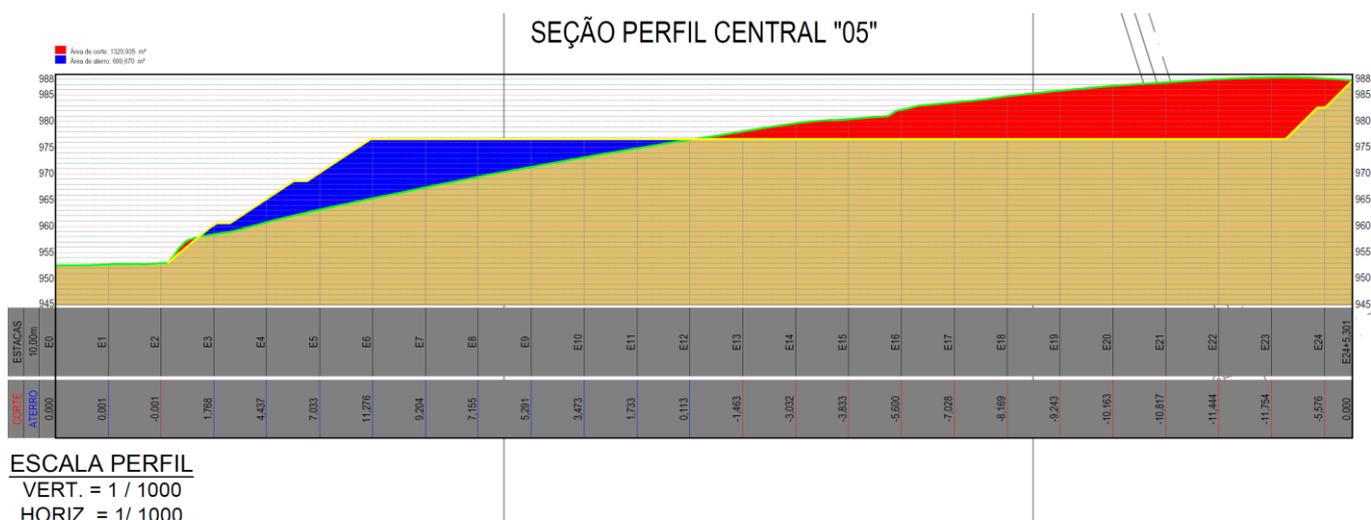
Perfil central da área do terreno, com as indicações da área de corte (vermelho) e aterro (azul)
